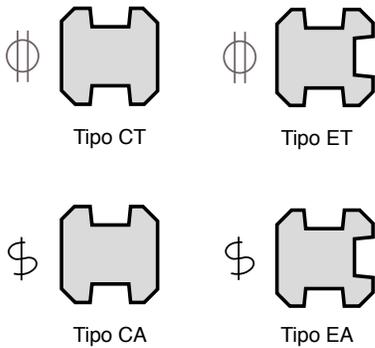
Detalle de los tipos de columna del sistema Prefa Holcim
